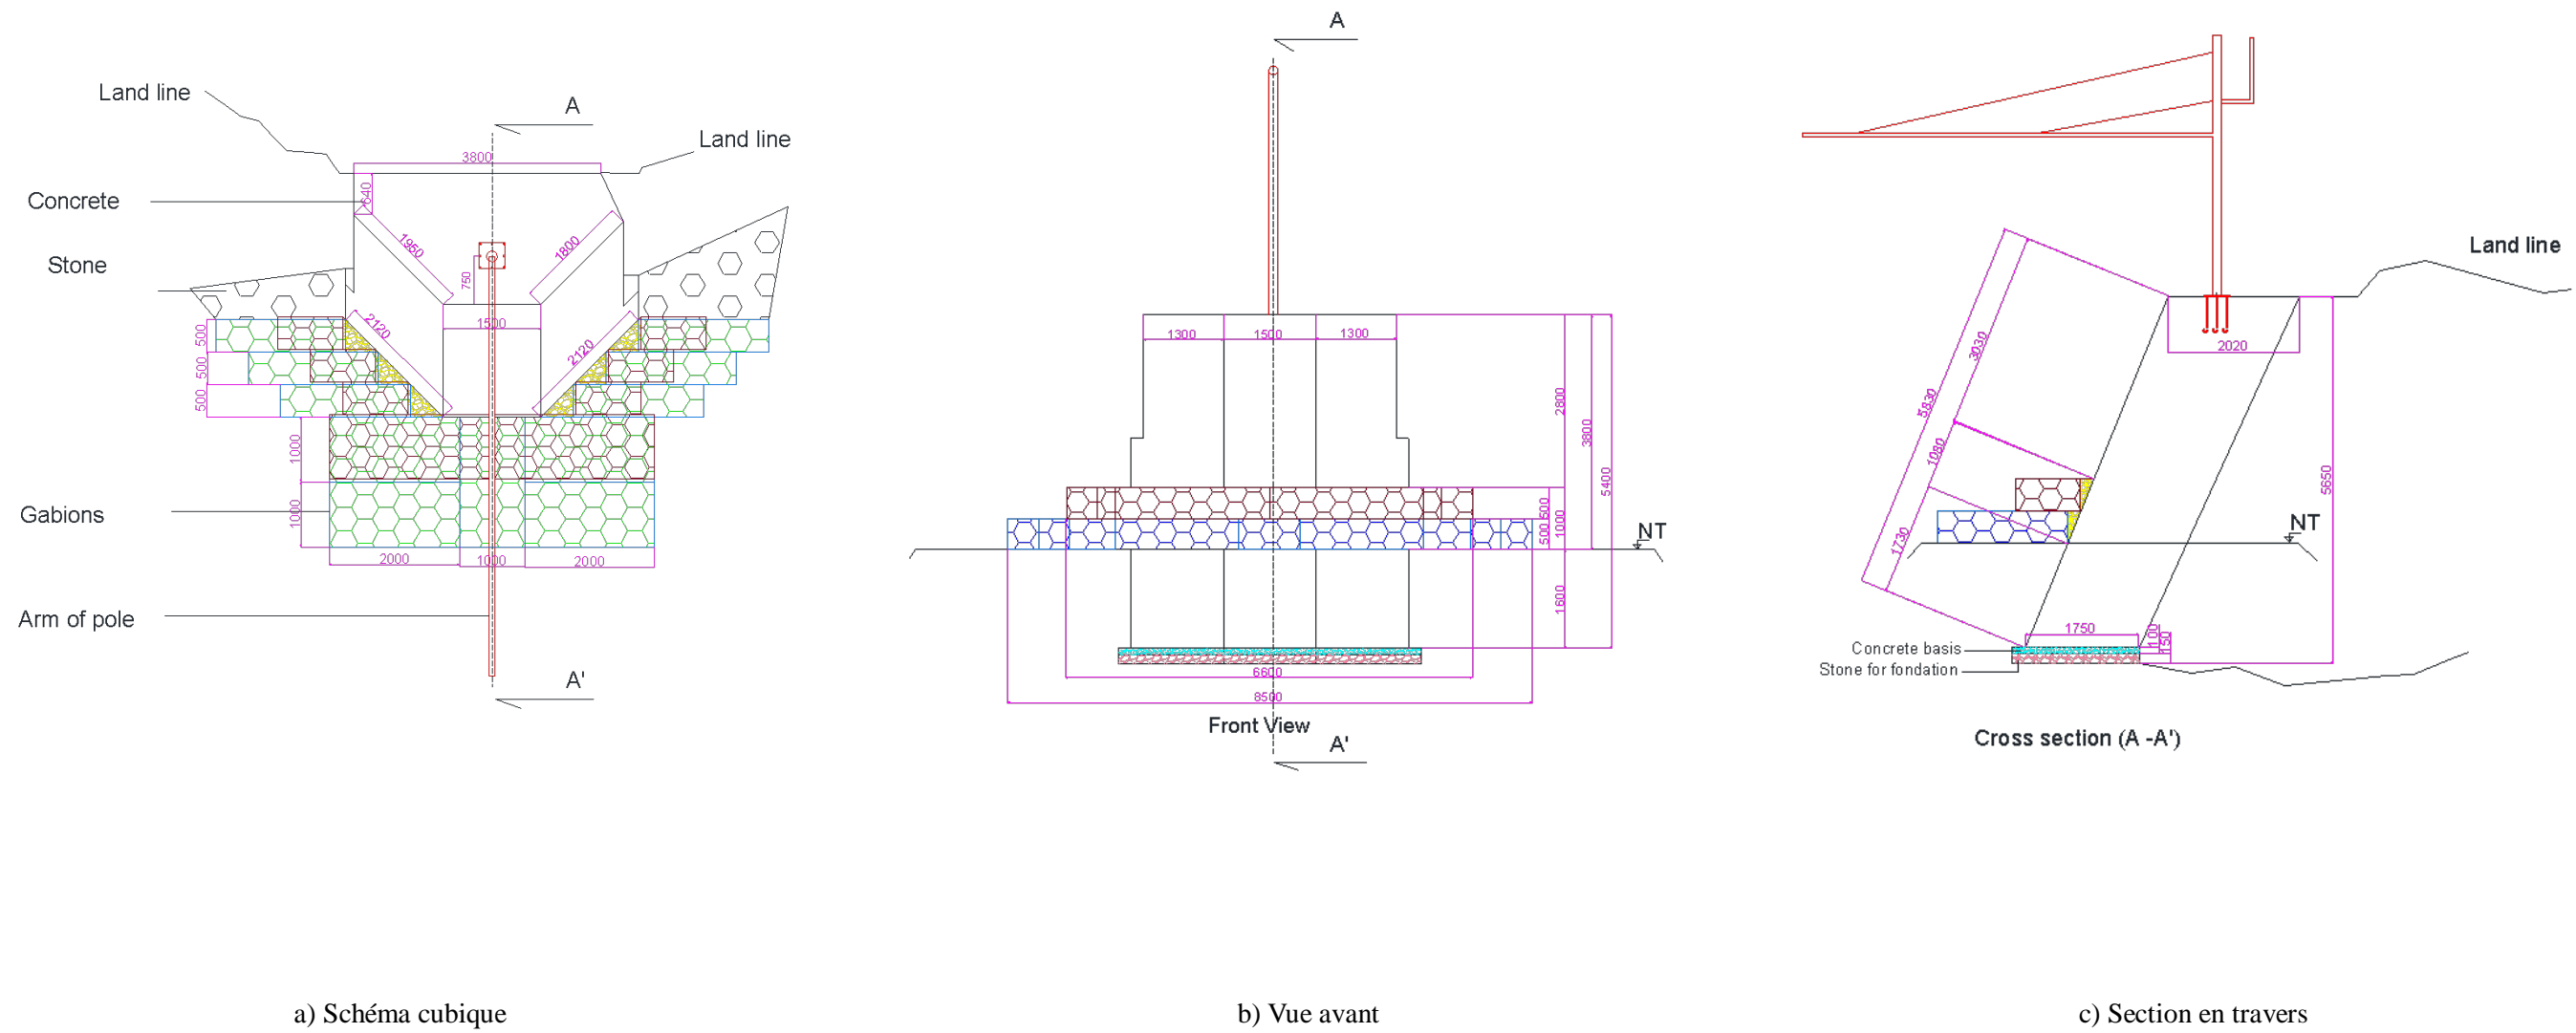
Dessin de réalisation de la foundation/Sous-structure
